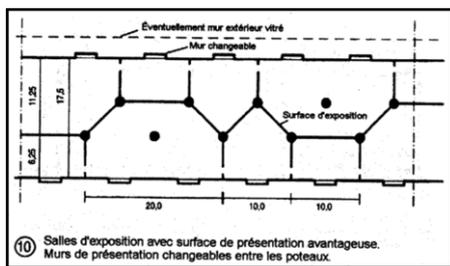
salles d'exposition avec surface de présentation avantageuse. Murs de présentation changeables entre les poteaux
